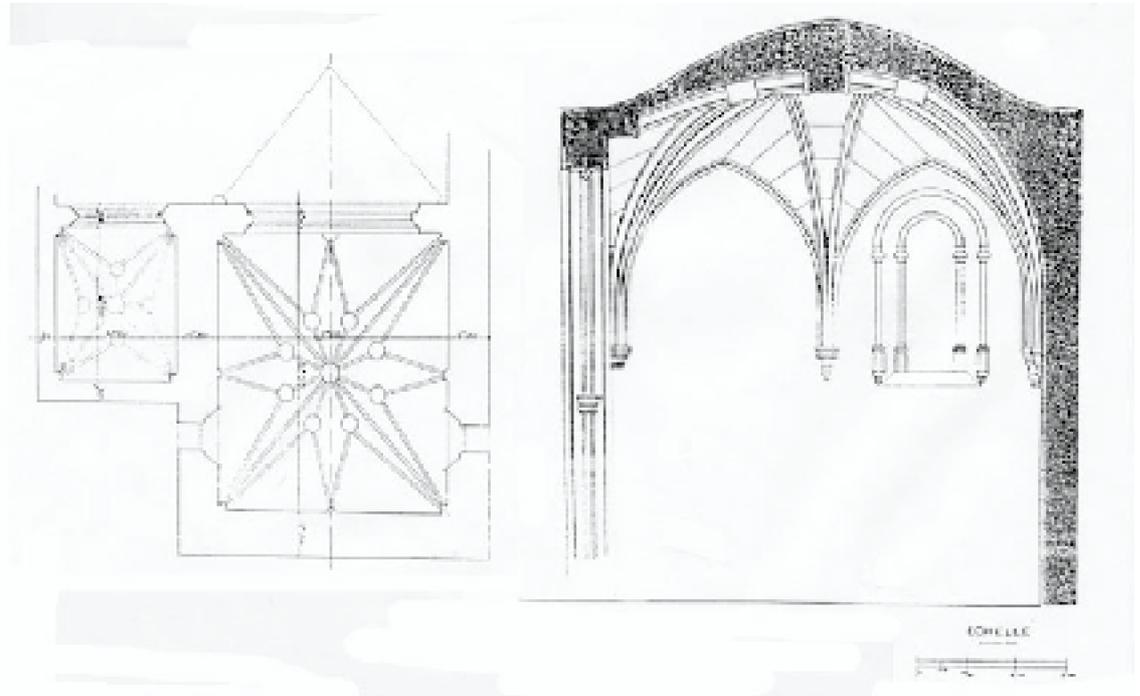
La cathédrale portugaise de Safi. Plan et coupe du chœur.
